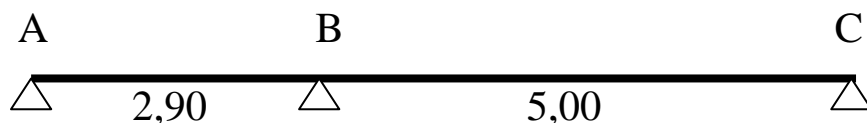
Schéma statique de la poutrelle type T2 (Sous sol).
